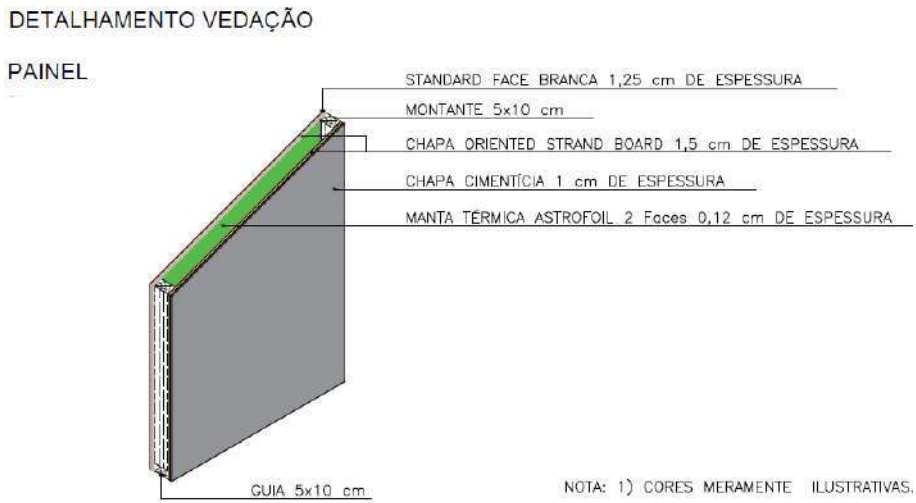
Composição Estrutural do Painel Simples em Wood Frame
